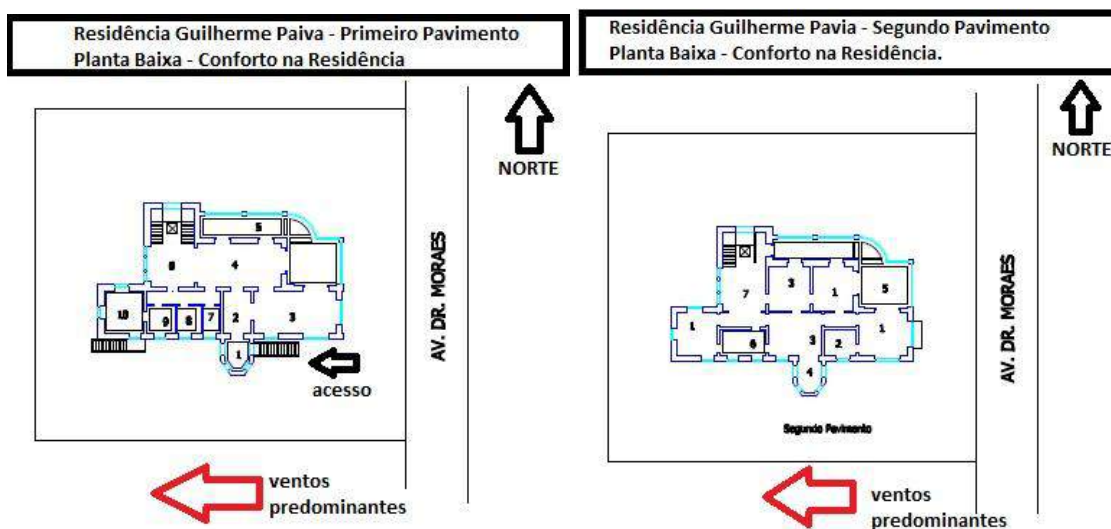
Planta de Conforto do 1º e 2º Pavimentos da Residência Guilherme Paiva (05).
